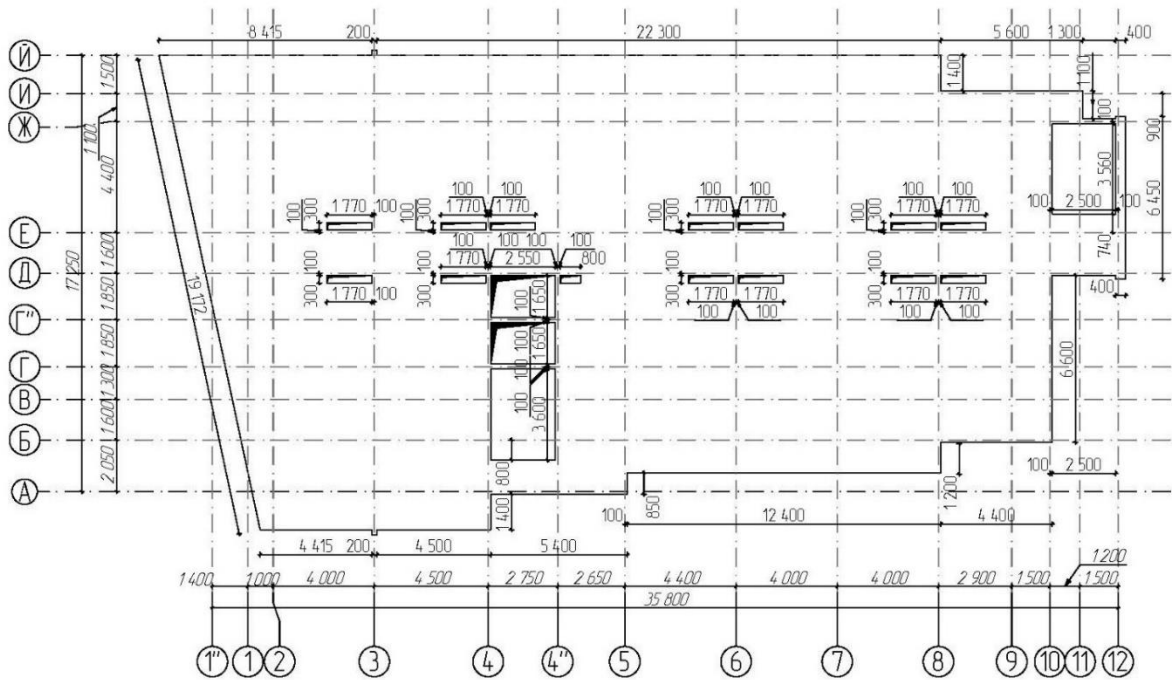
Схема расположения ж/б плиты перекрытия
